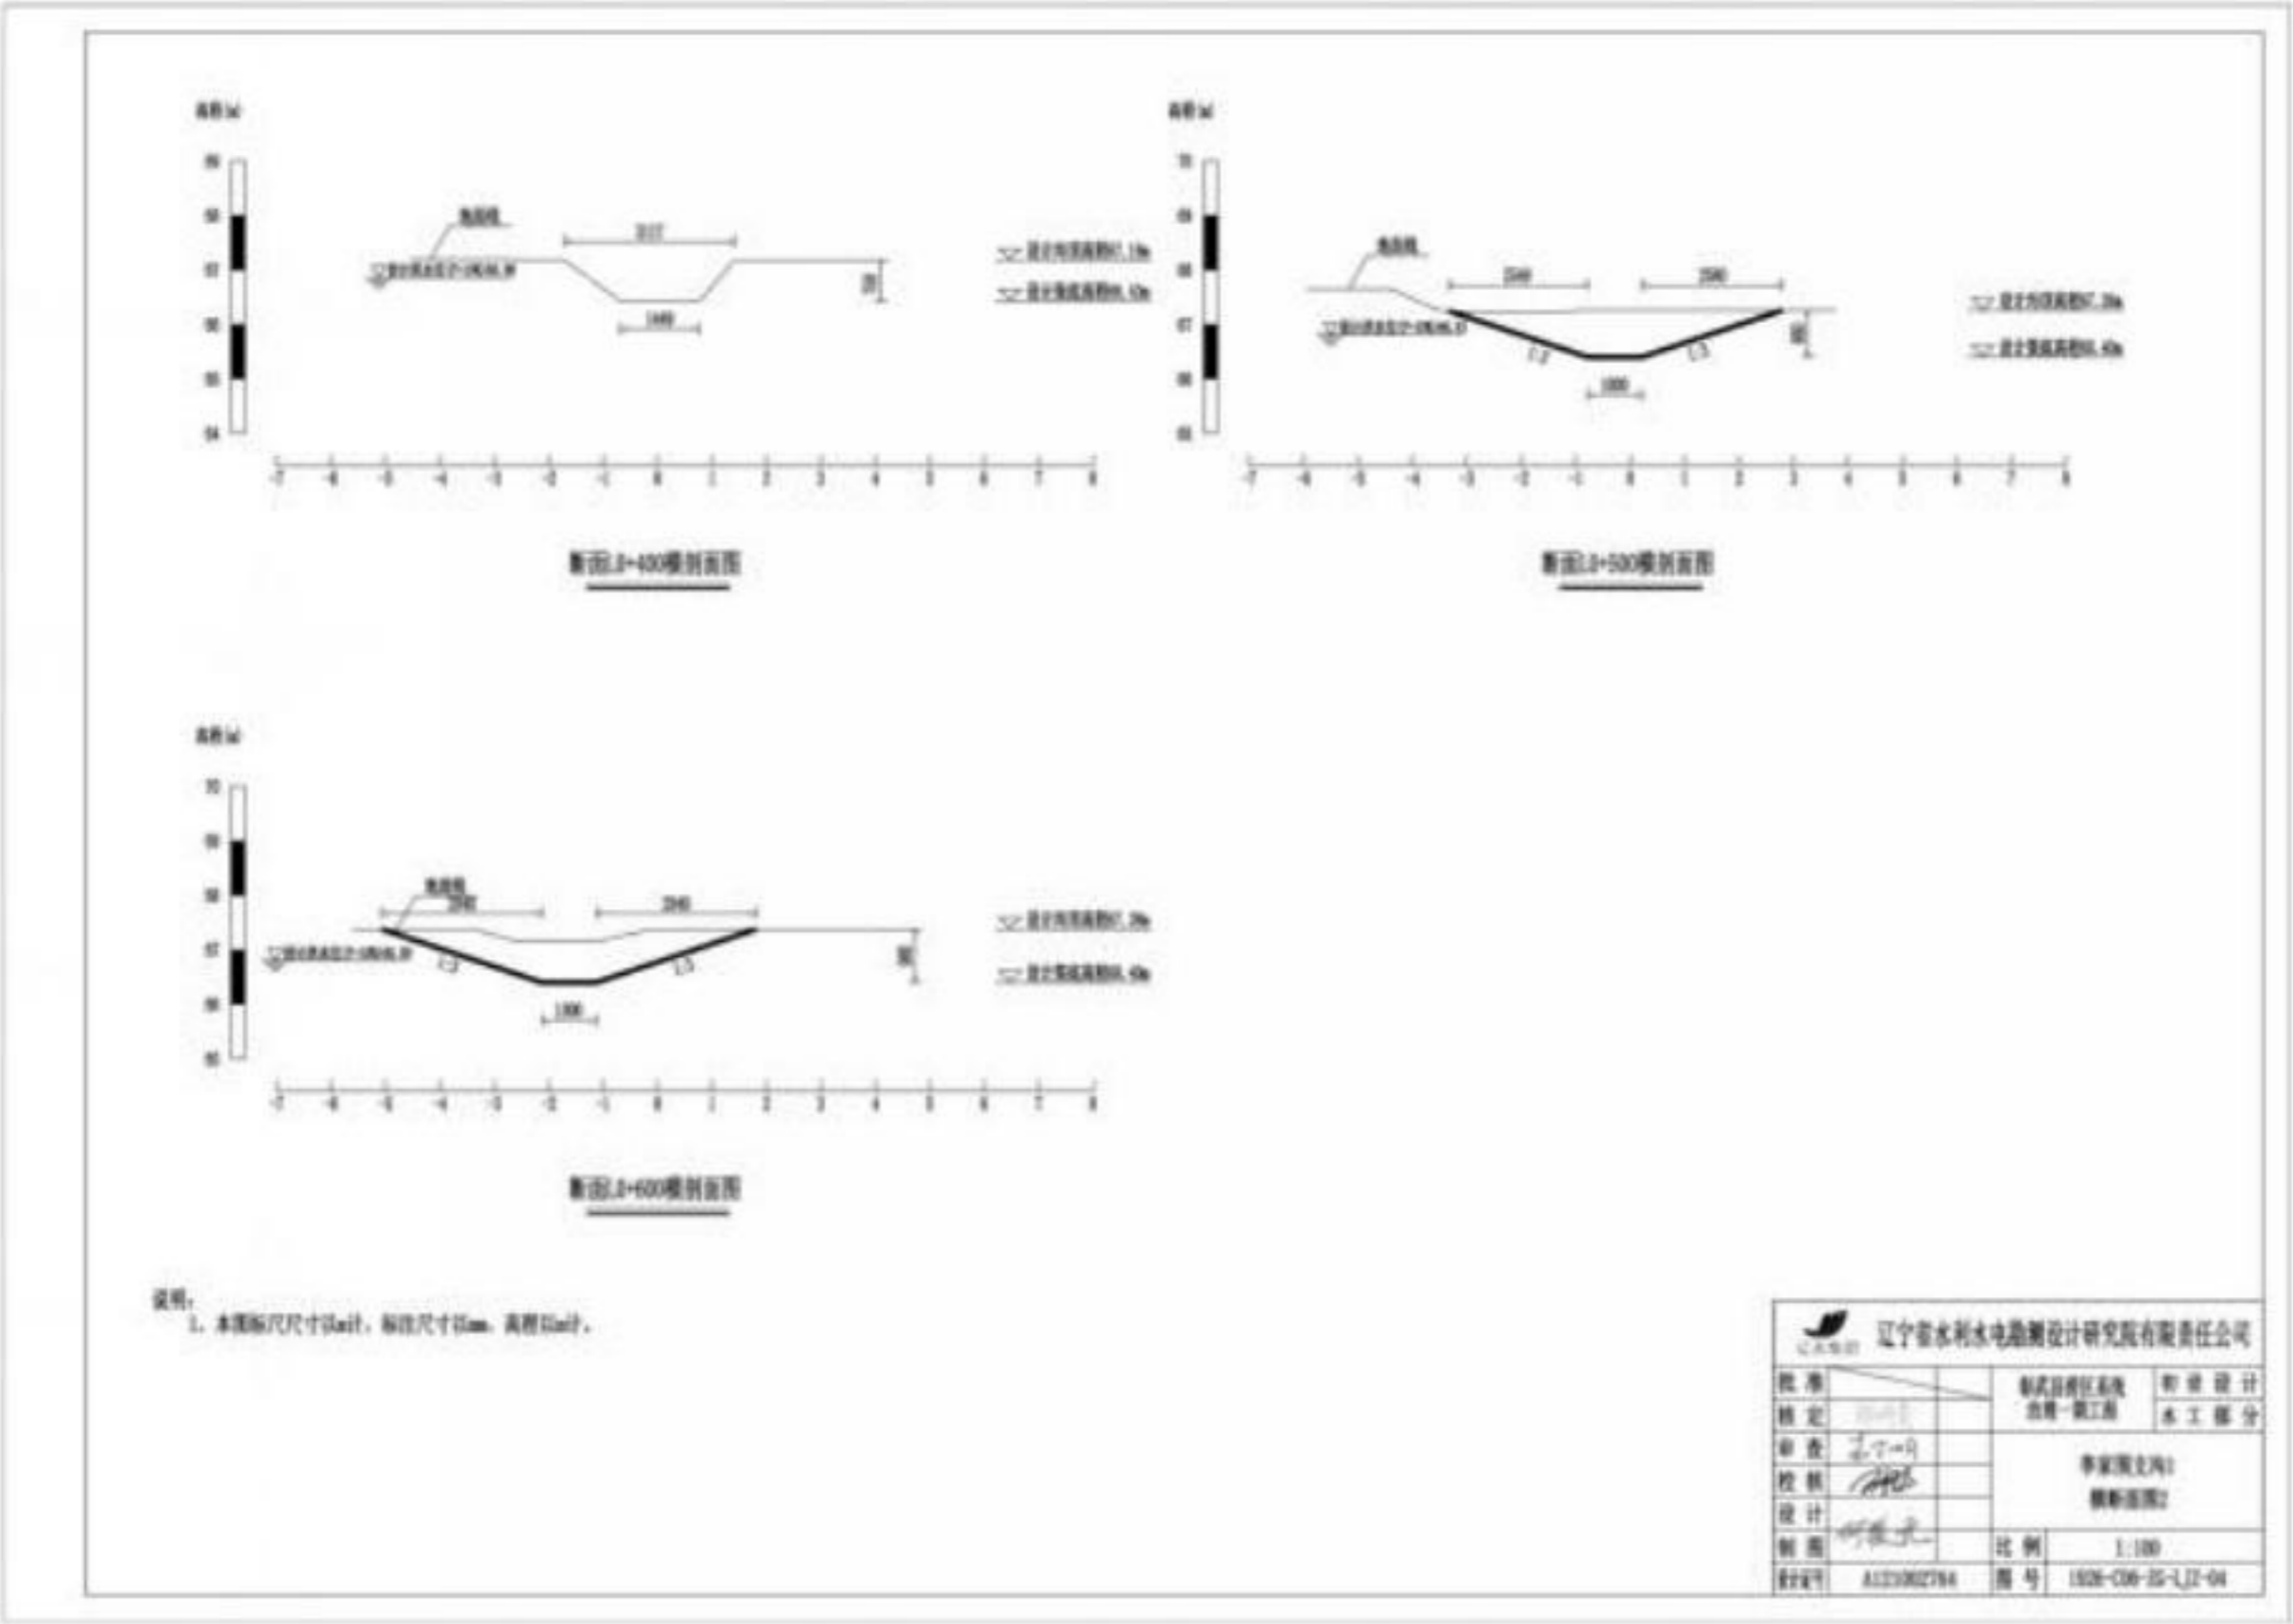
(2) 两家子镇李家围支沟 1 剖面图
